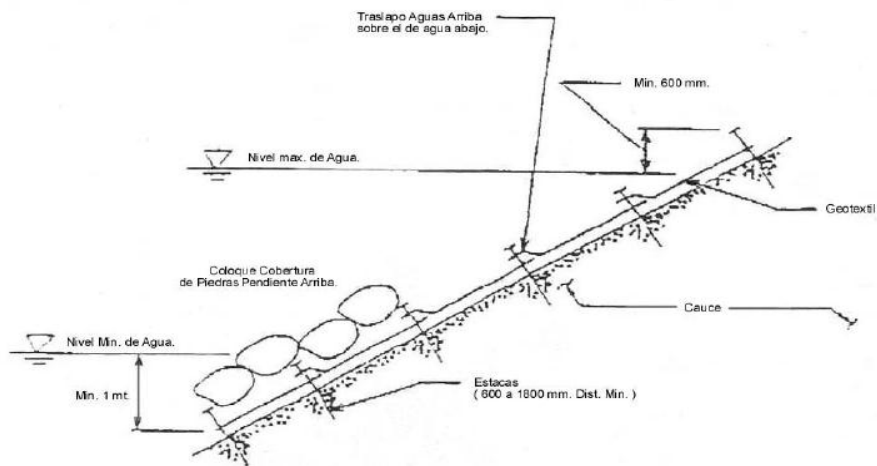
Sección Transversal de Taludes con Enrocado (Rip Rap).
